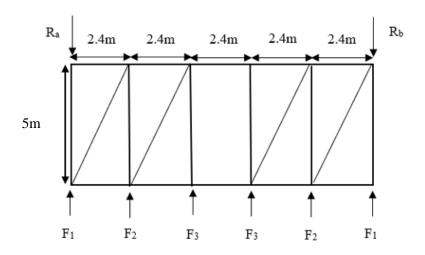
Schéma statique de la poutre au vent de pignon avant
